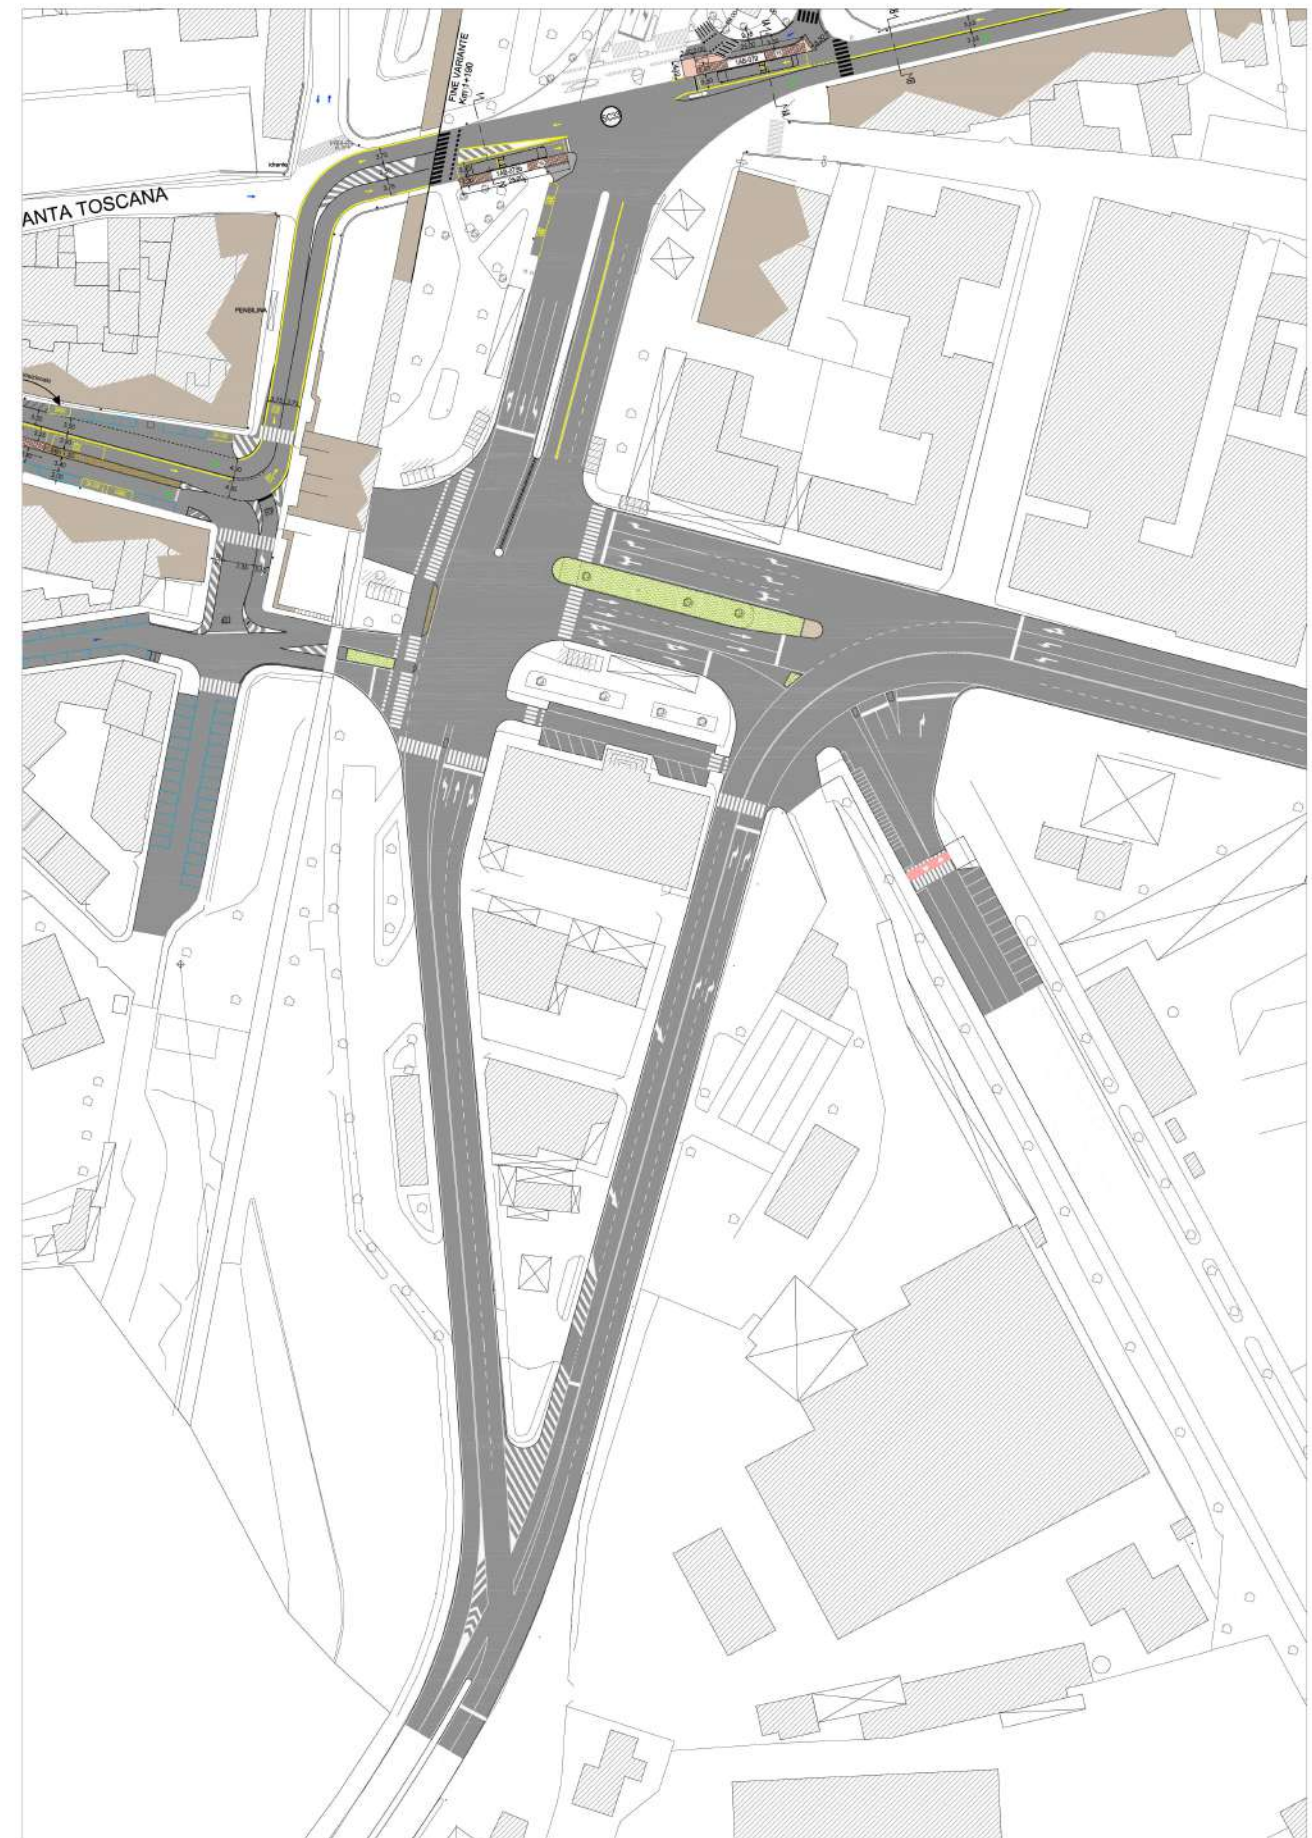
Planimetria Stato di Fatto con PE Filobus
